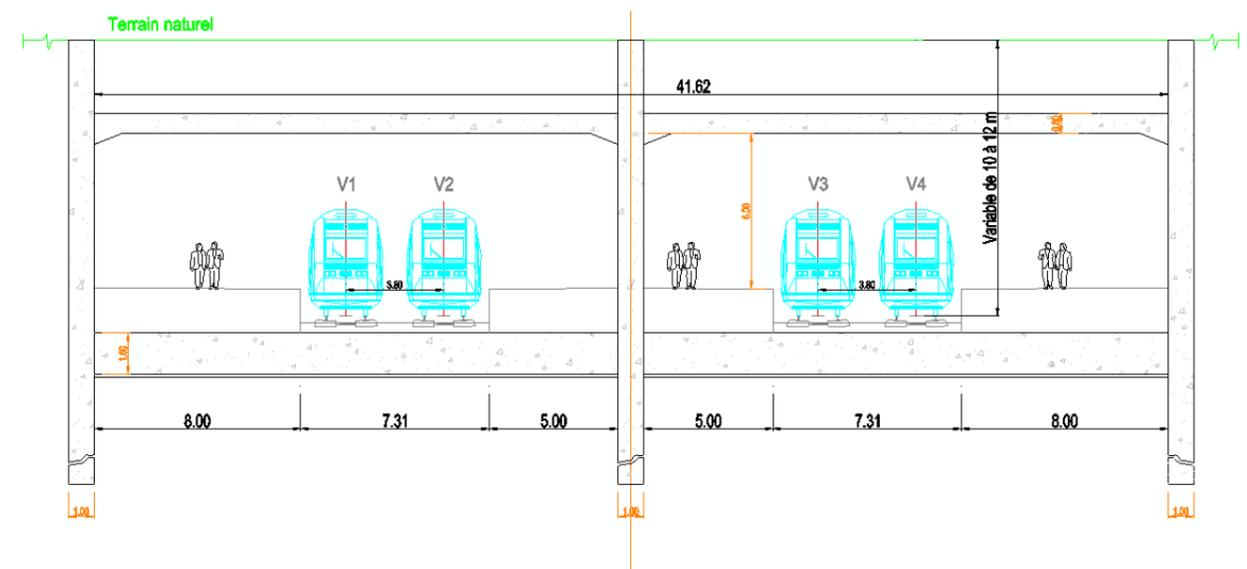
Coupe GC de la gare de Lesquin (Coupe A-A)
